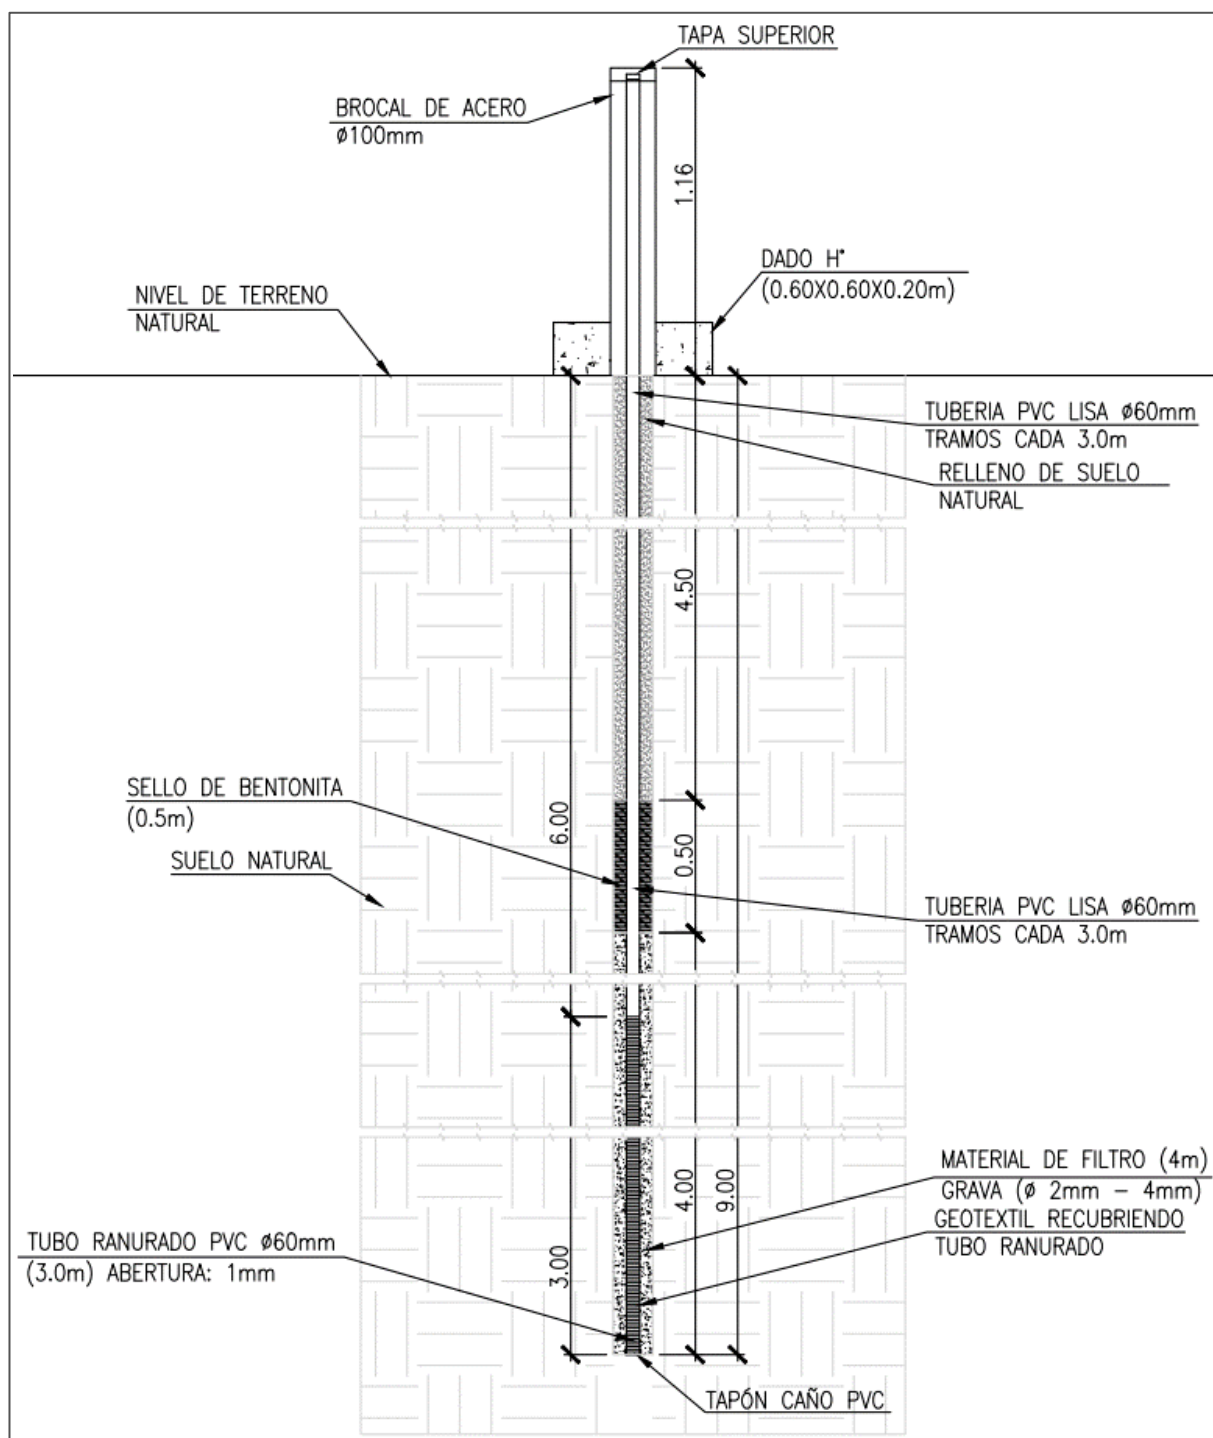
Esquema en detalle del perfil SRK-2023-BH07 b
